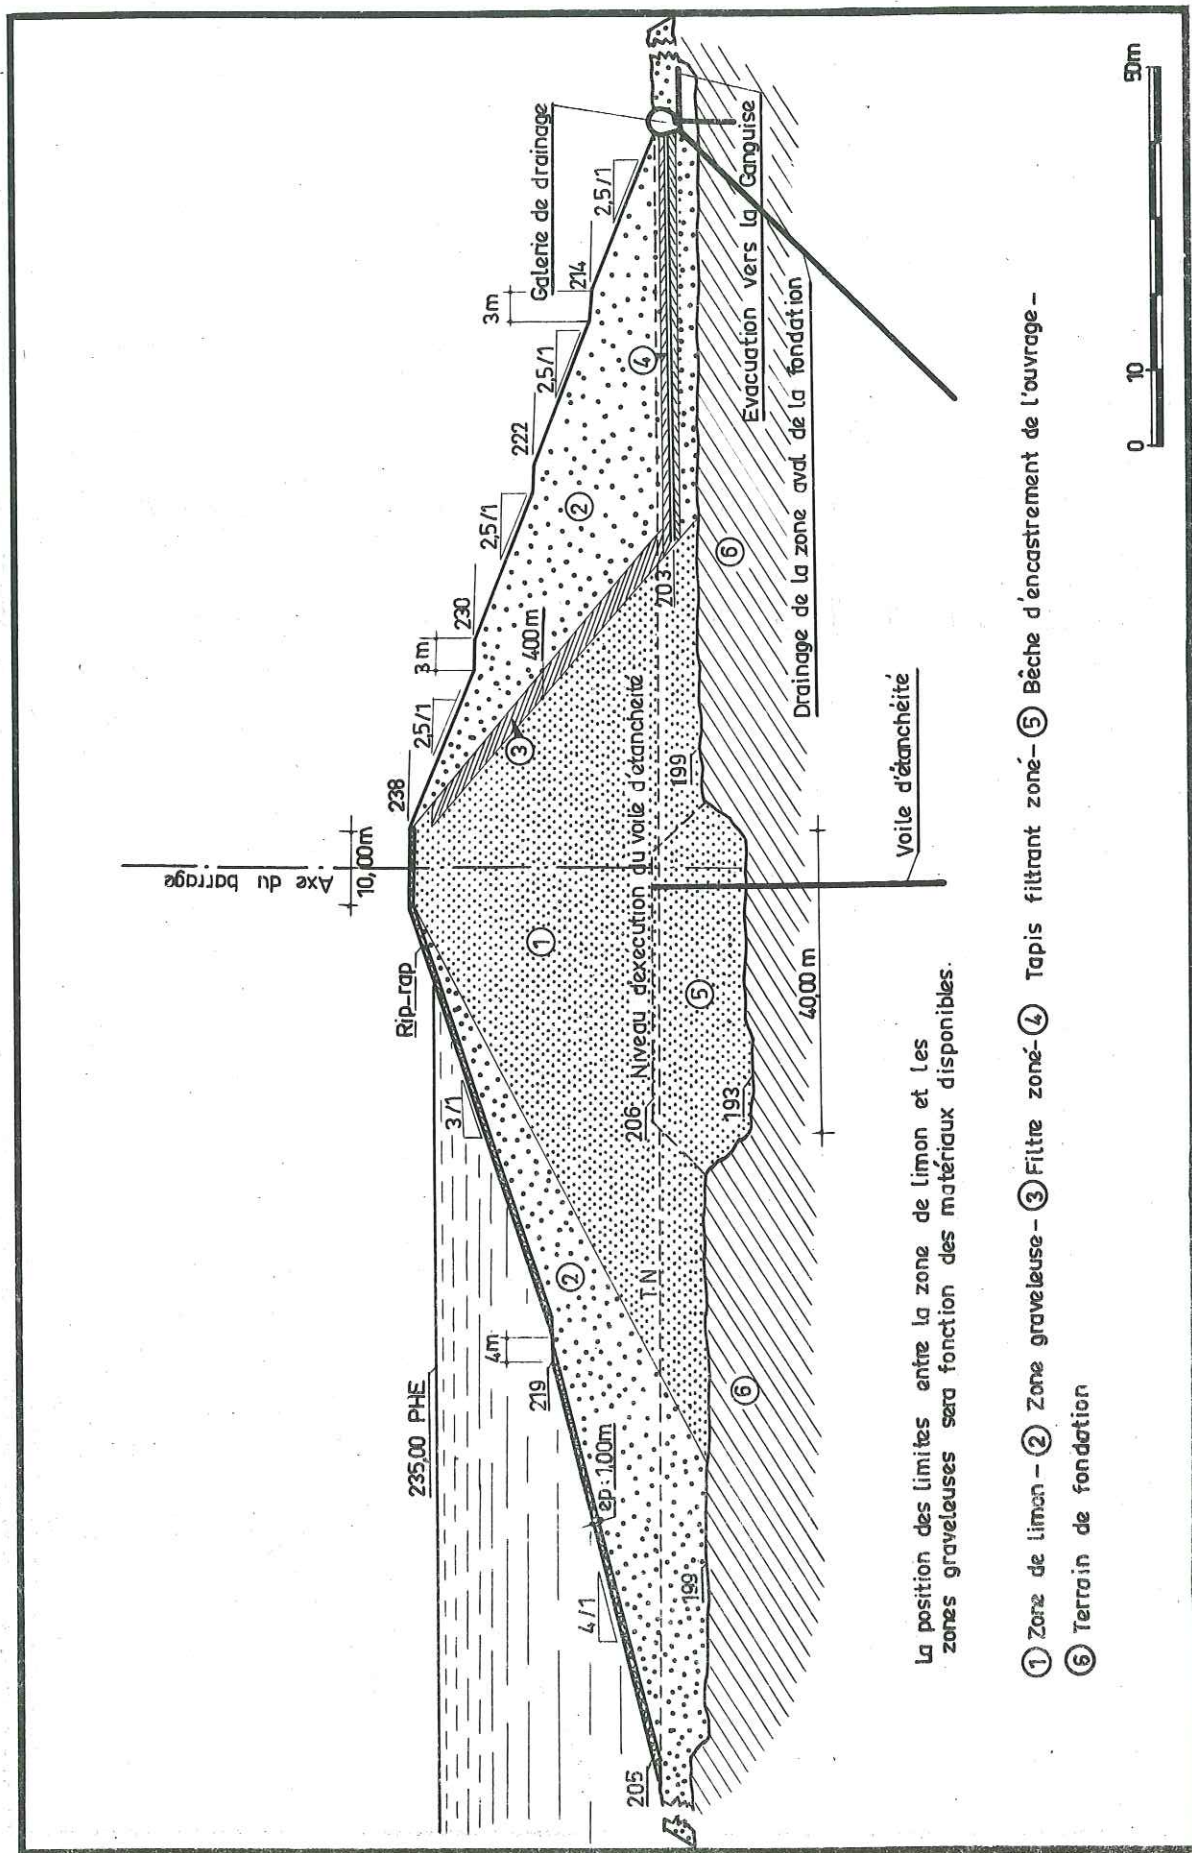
PLAN DU PROJET DU BARRAGE DE L'ESTRADE
